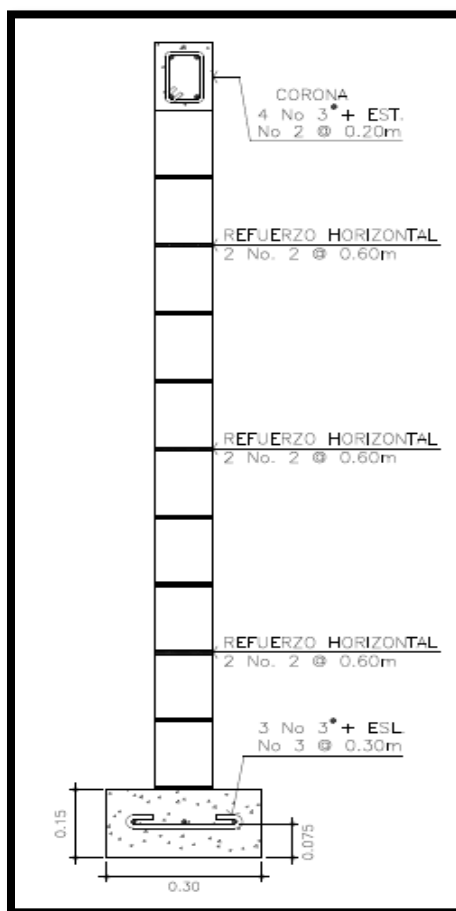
Sección de muro con refuerzo horizontal interior.
